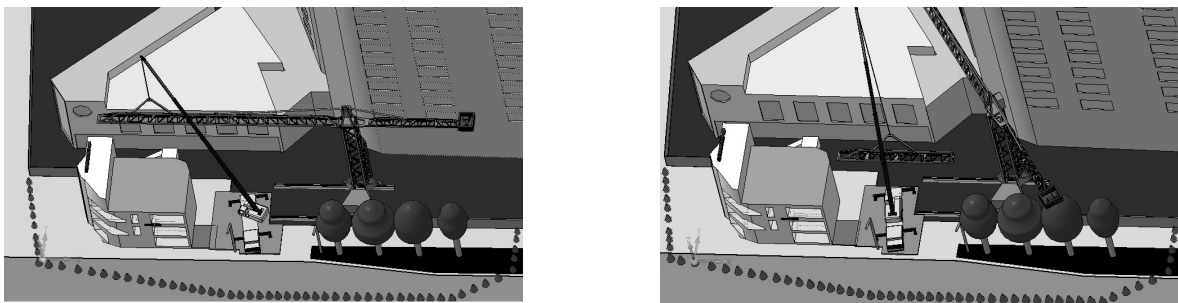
Ситуаційний план будівельної площадки перед демонтажем
